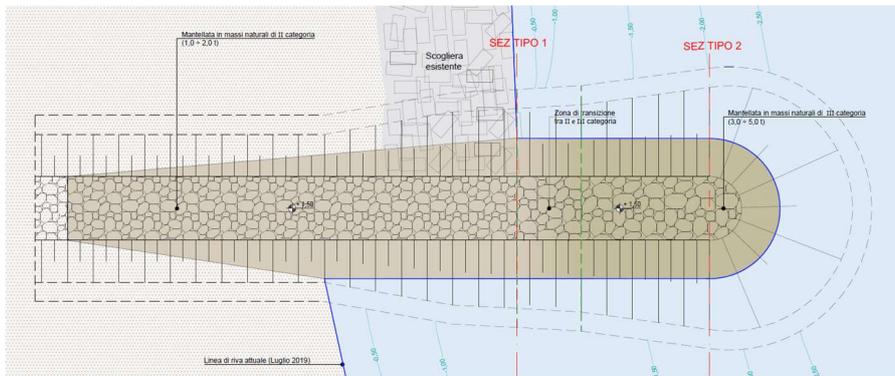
Stralcio planimetrico pennello Marina di Cetraro
